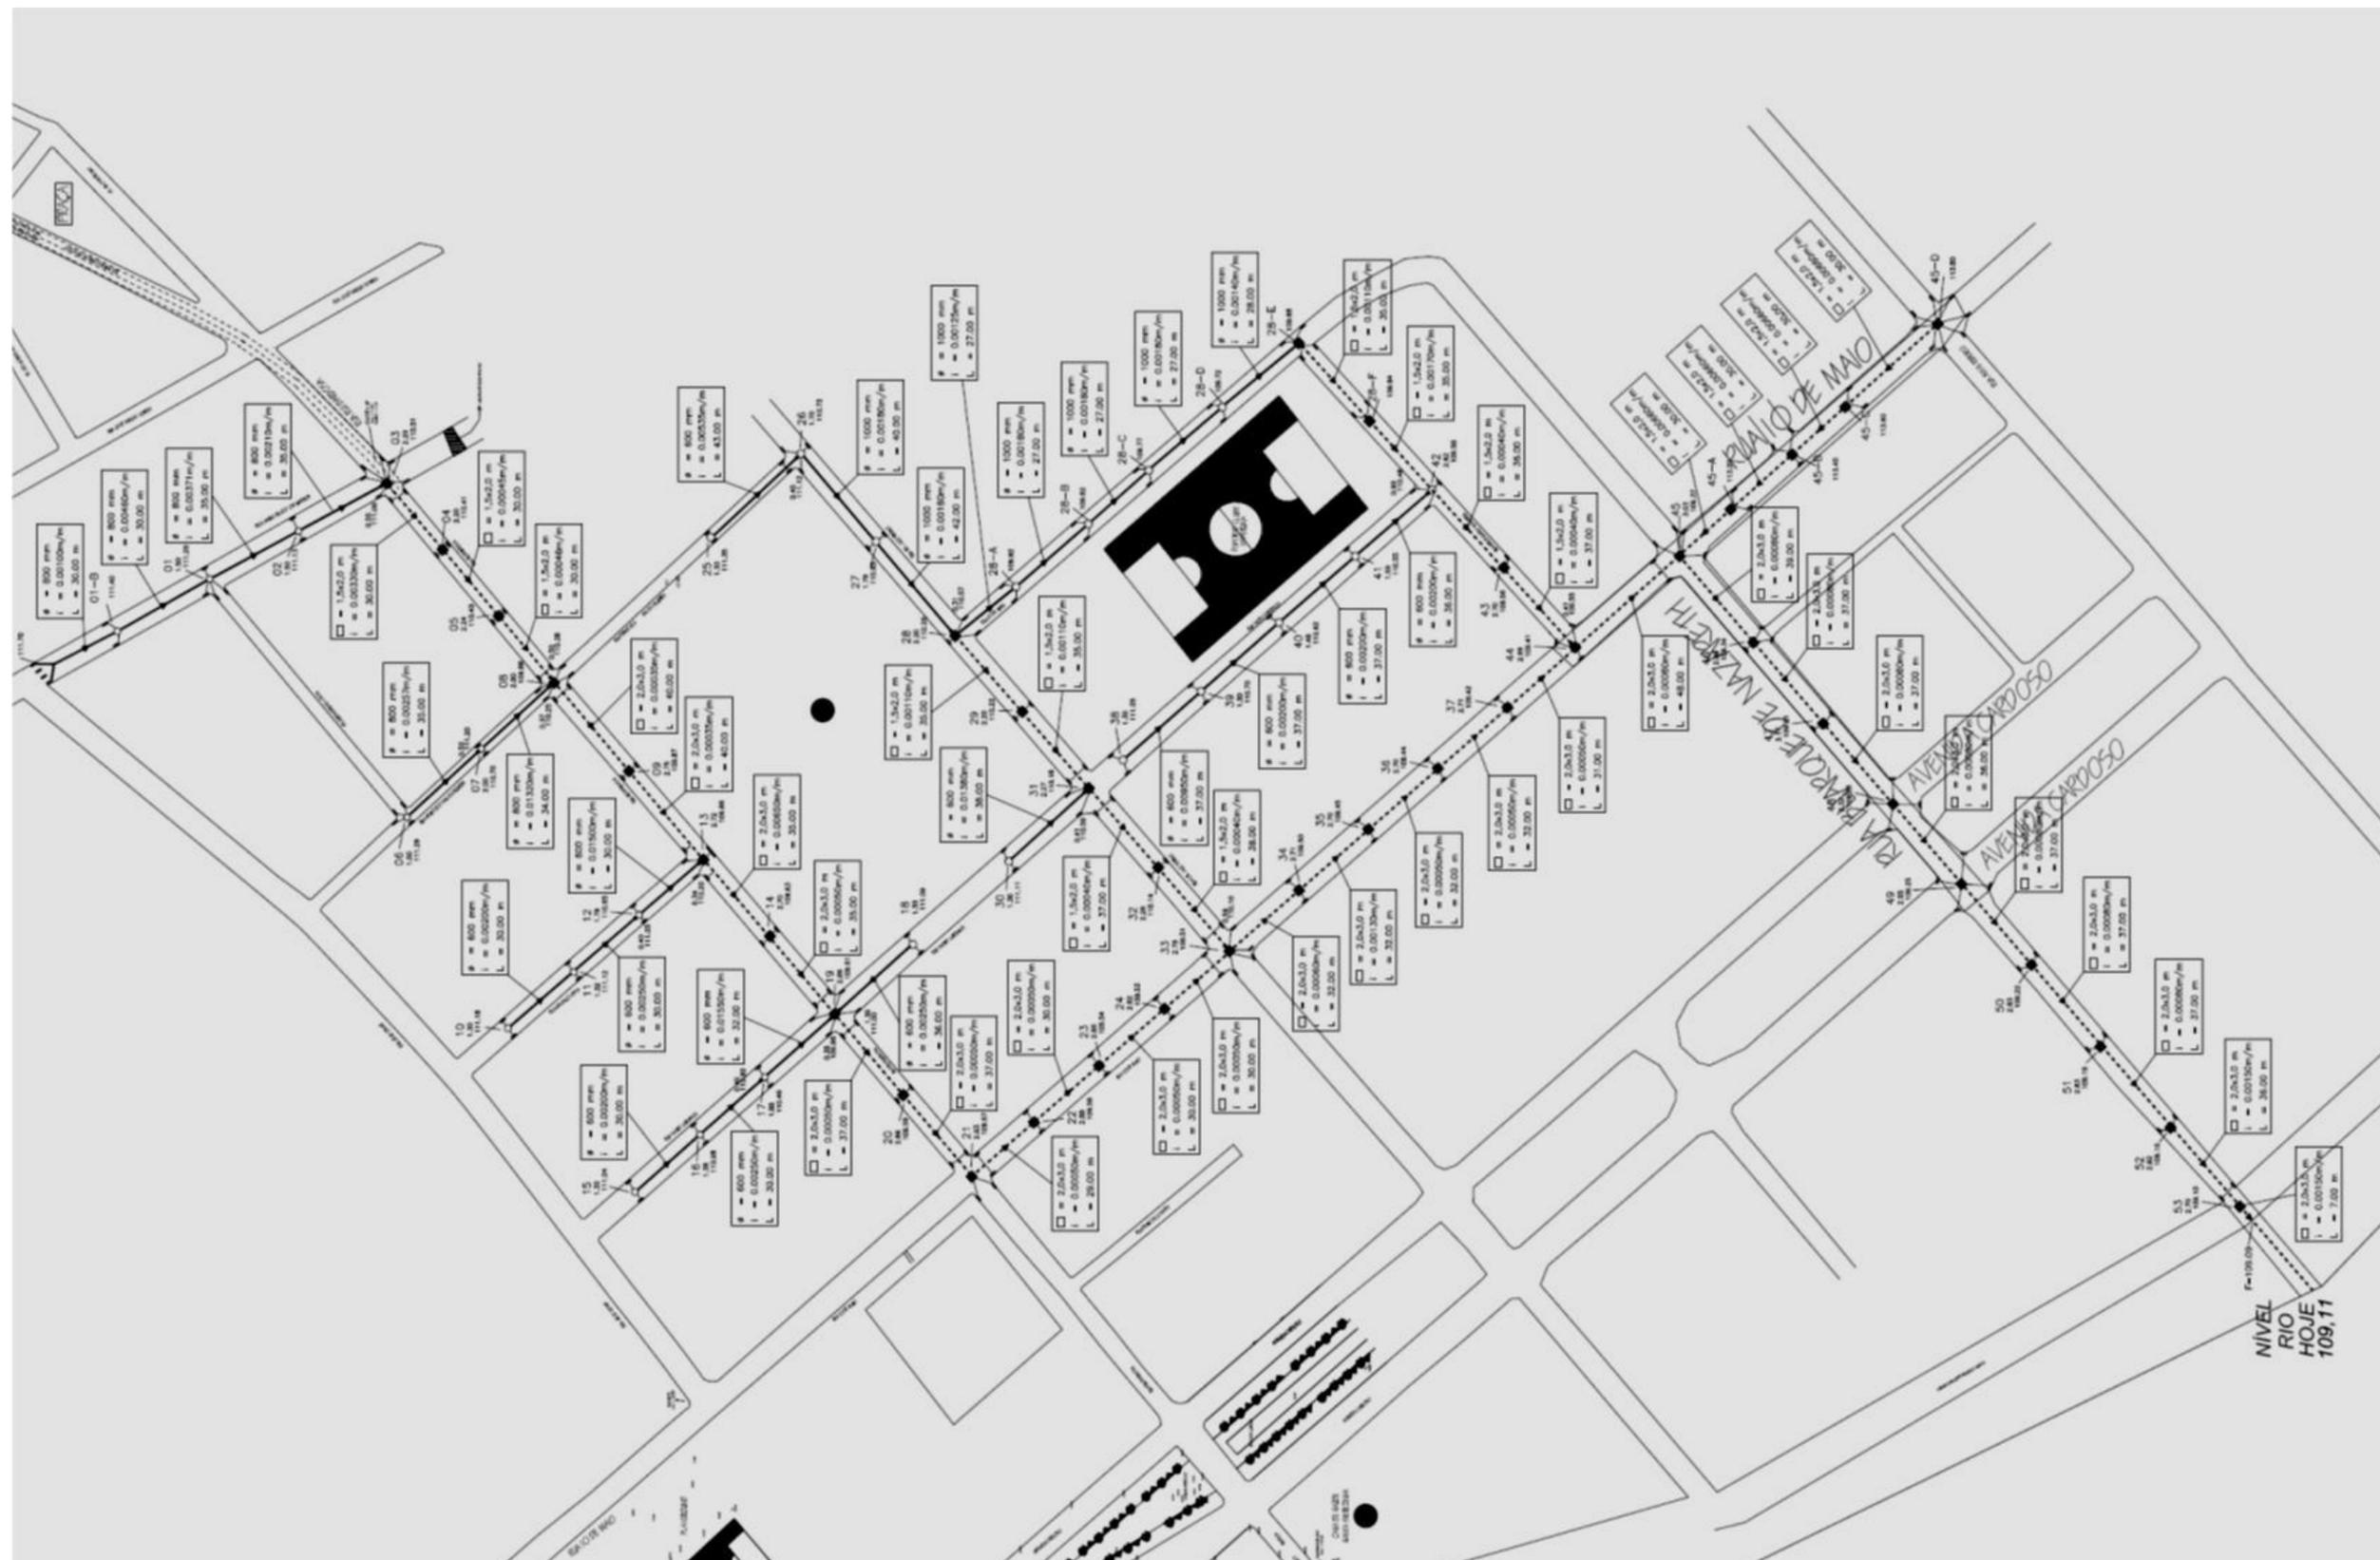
Traçado da Obra de Esgotamento do bairro Vinhosa
